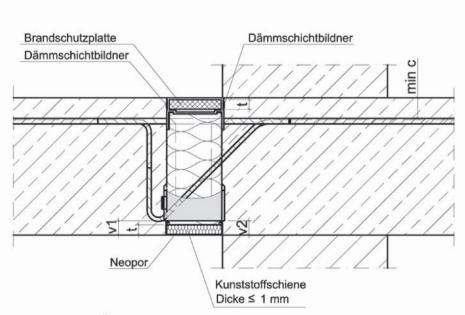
Schöck Isokorb® Typ K und Typ KF (Ausführungsvariante C) gem. Abschnitt 3.1.2
